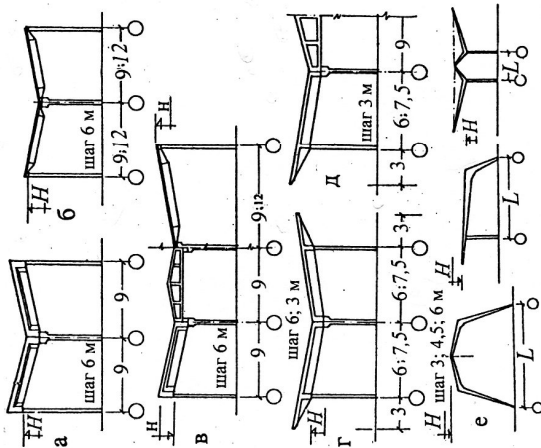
Нетиповые конструктивные схемы каркасов из типовых конструкций по УЗК-2 (варианты)
